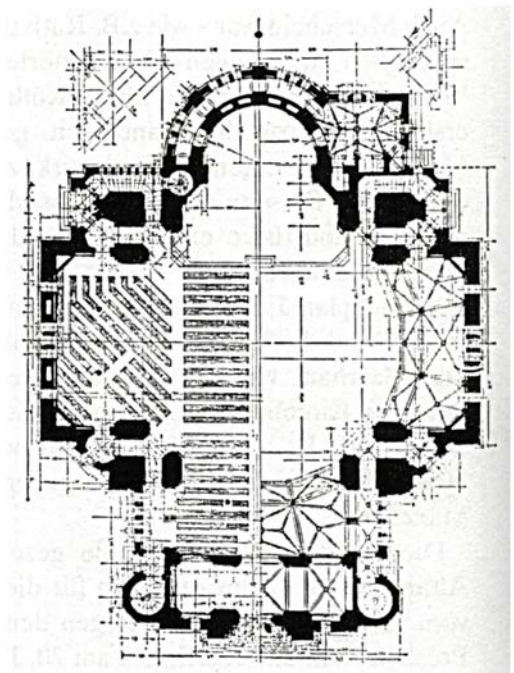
Grundriss Erd-/Emporengeschoss
